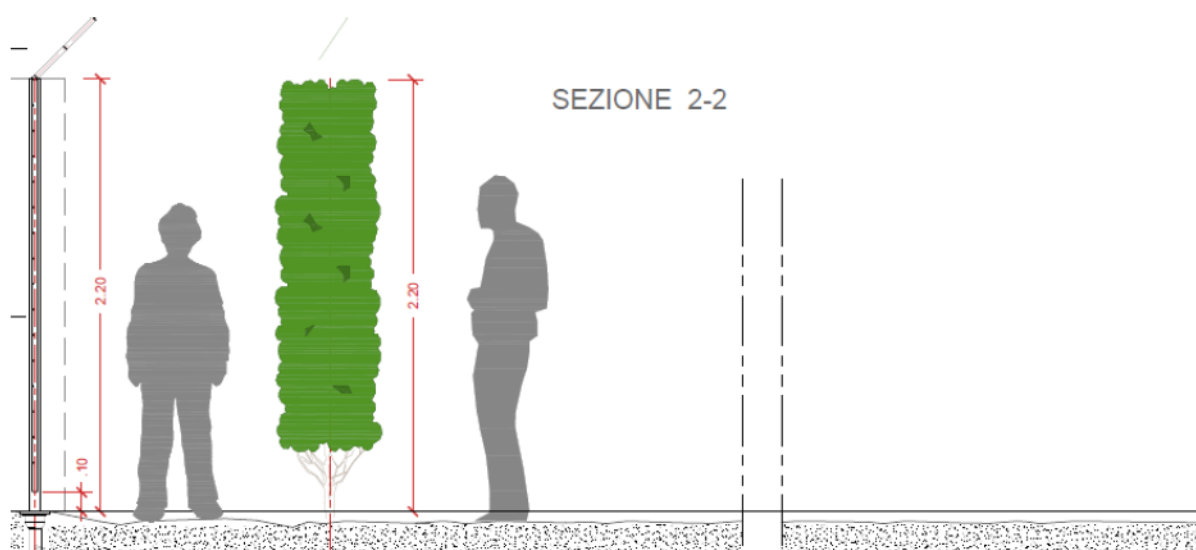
Prospetto recinzione perimetrale con mitigazione – sistema da adottare.
